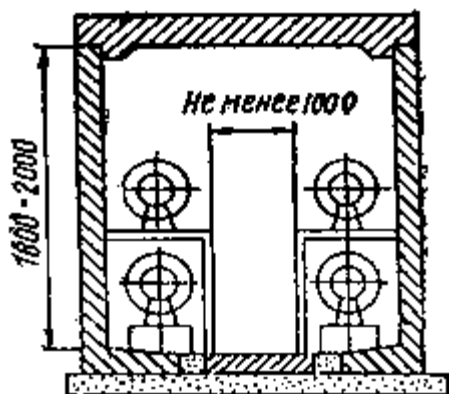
Проходной канал из сборных железобетонных блоков
